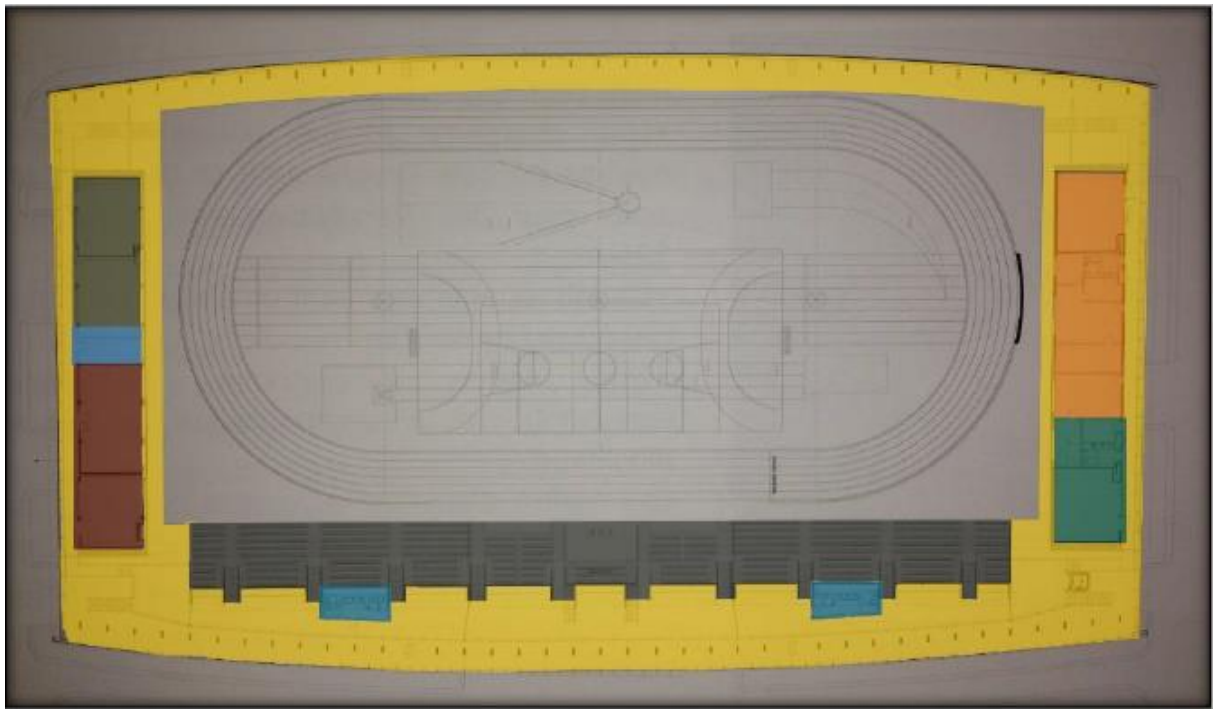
Plan du 1er étage du projet de Ben Aknoun.
